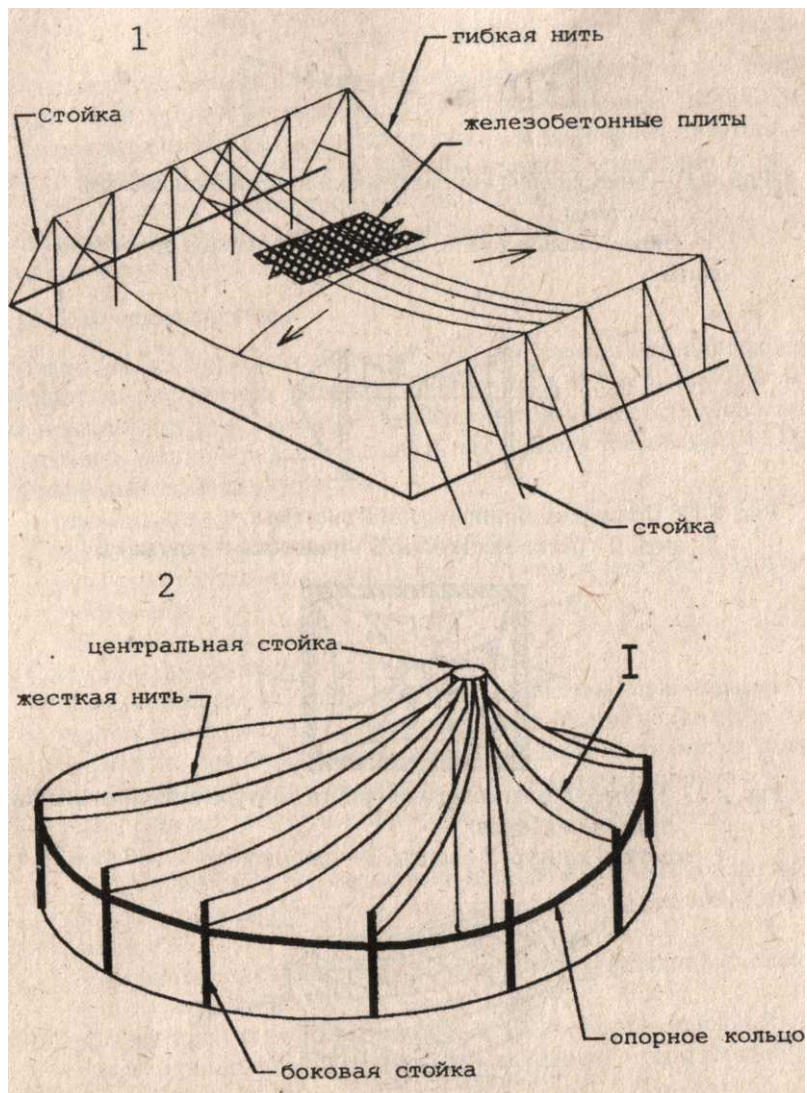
Примеры конструктивных решений со стабилизацией: 1 - железобетонными плитами, 2 - с помощью жестких нитей
